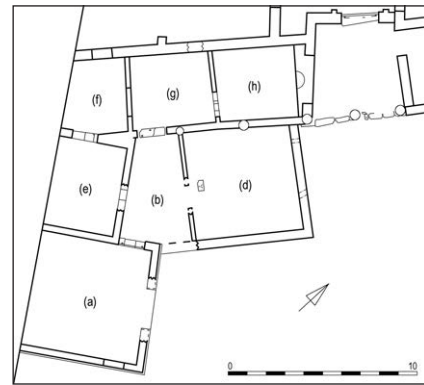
Insula dell'Aquila, Grundriss
